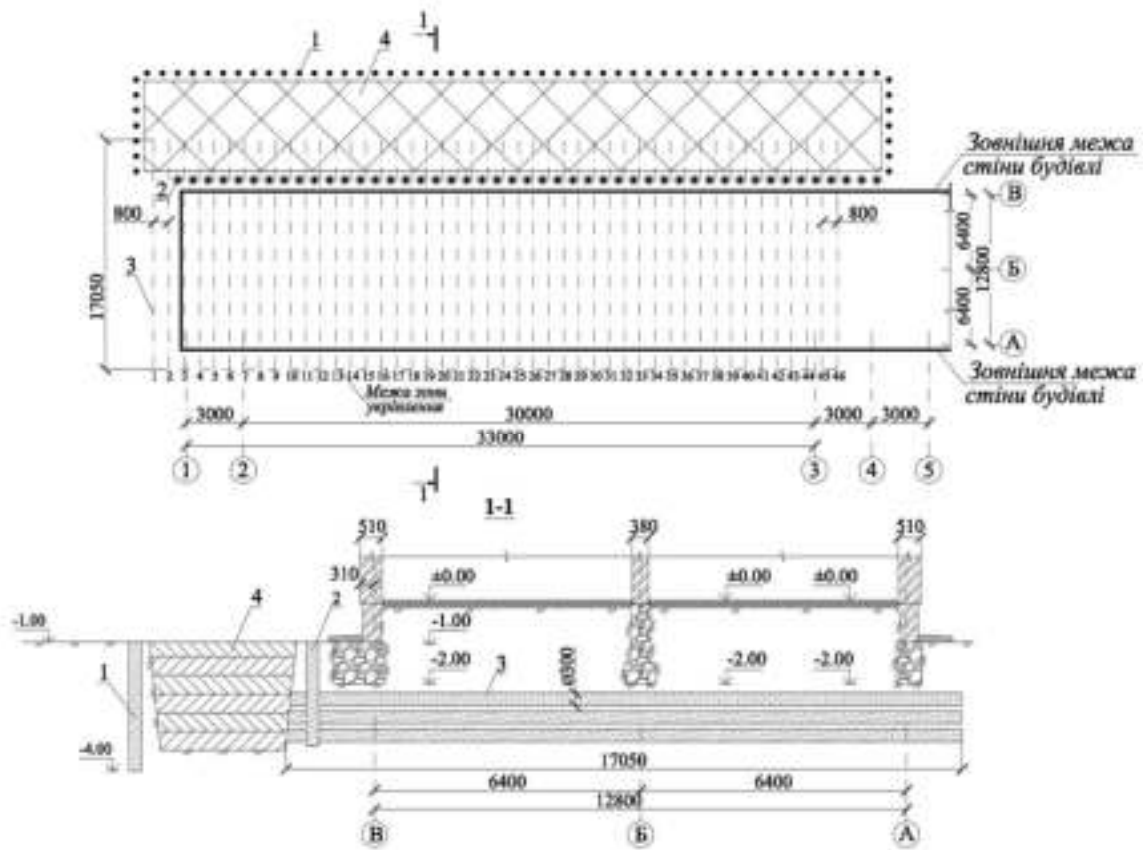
Схема плану та розрізу будівлі з підсиленою основою фундаментів: 1 - ГЦЕ укріплення укосів; 2 - вертикальний ГЦЕ підпірної стінки; 3 - горизонтальний ГЦЕ; 4 - ґрунтова подушка
